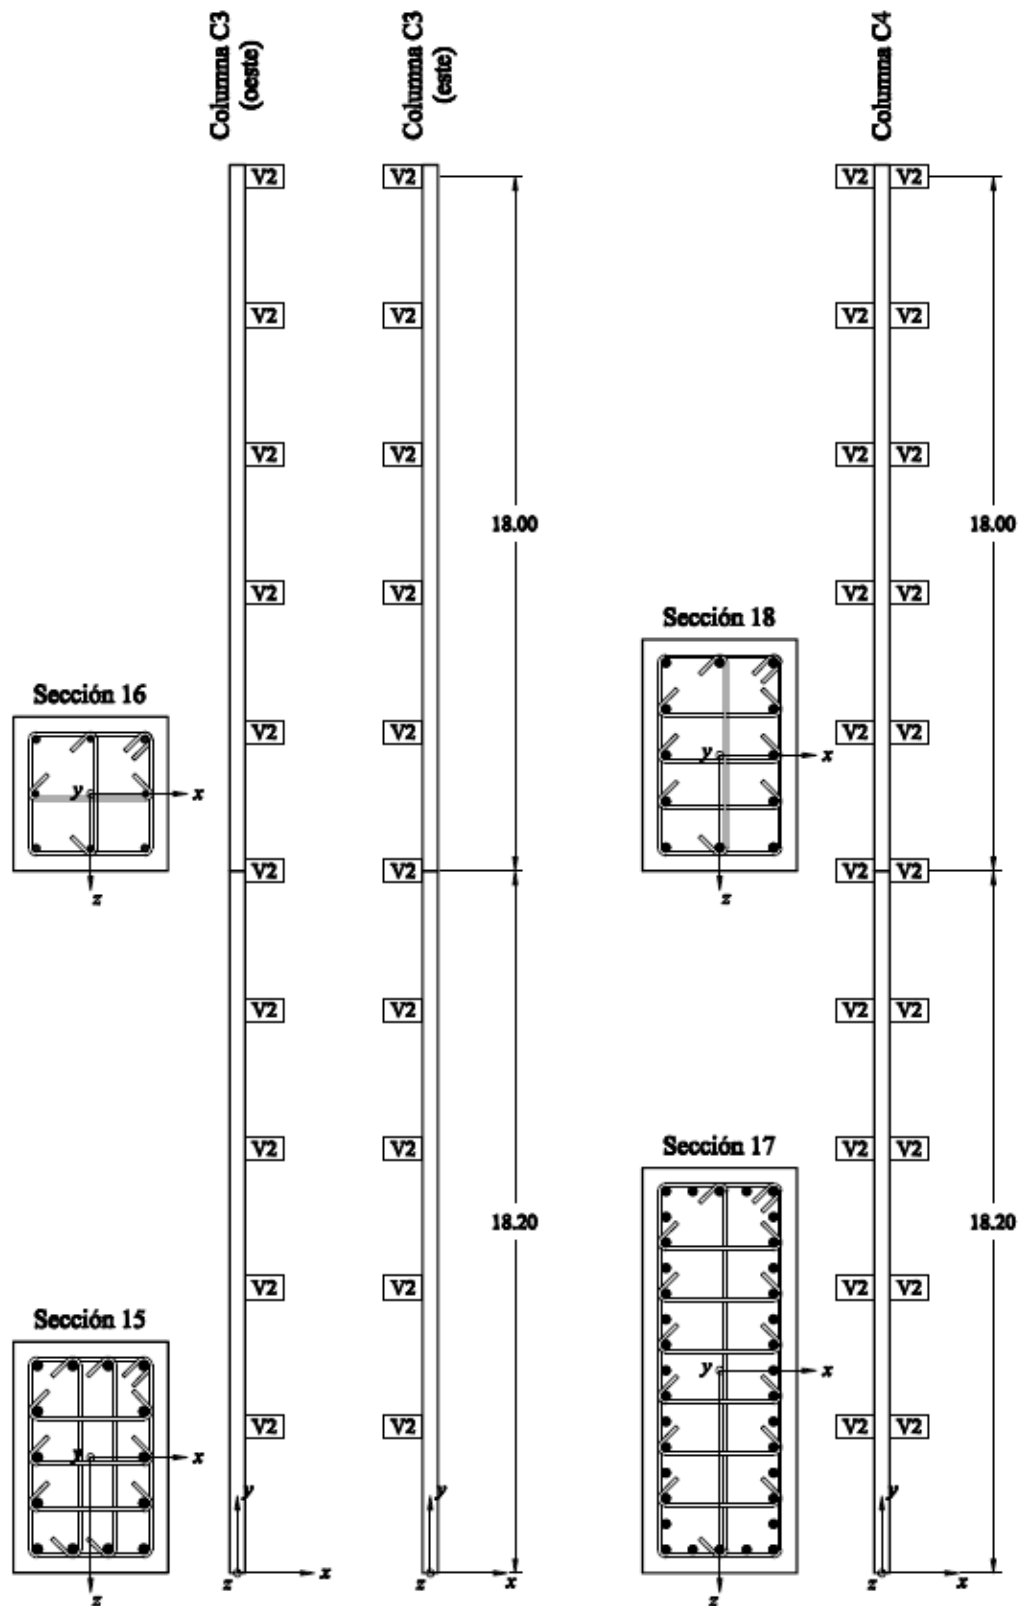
Columnas C3 y C4. Vista de Elevación (Unidades en m)
